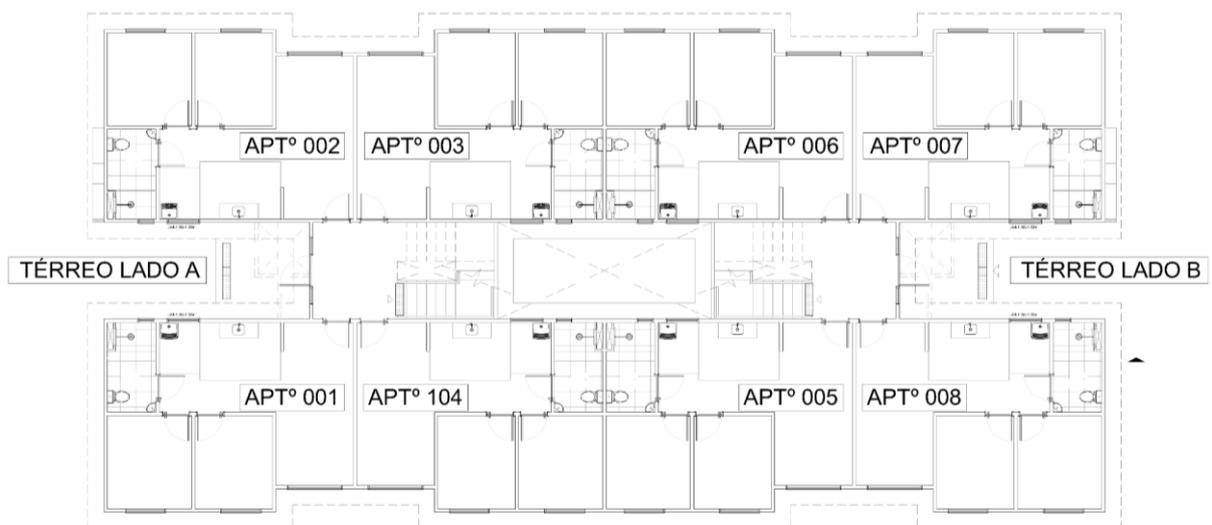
Planta baixa tipo disponibilizada pela construtora
